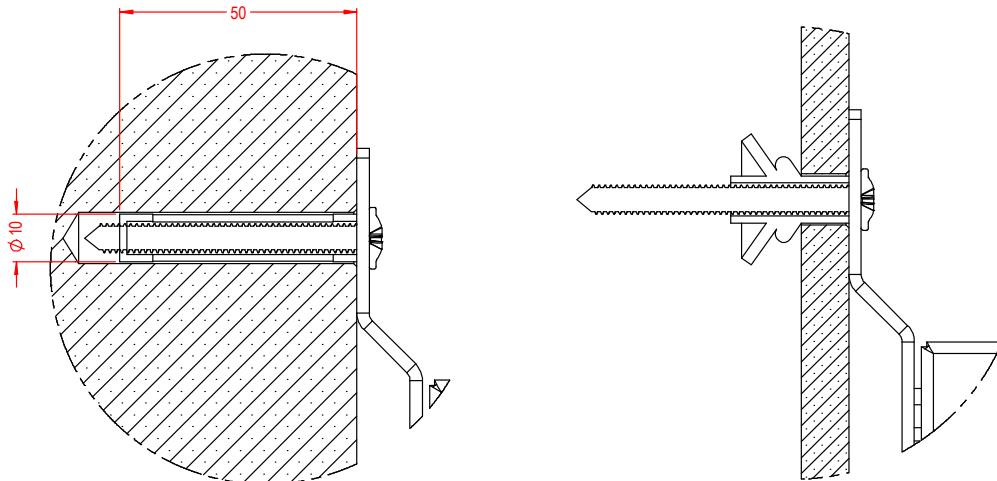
Detalhes de fixação dos painéis em parede de concreto e tijolo oco
